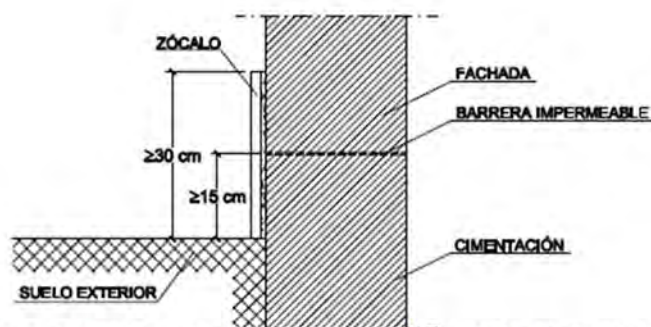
Ejemplo de arranque de la fachada desde la cimentación
